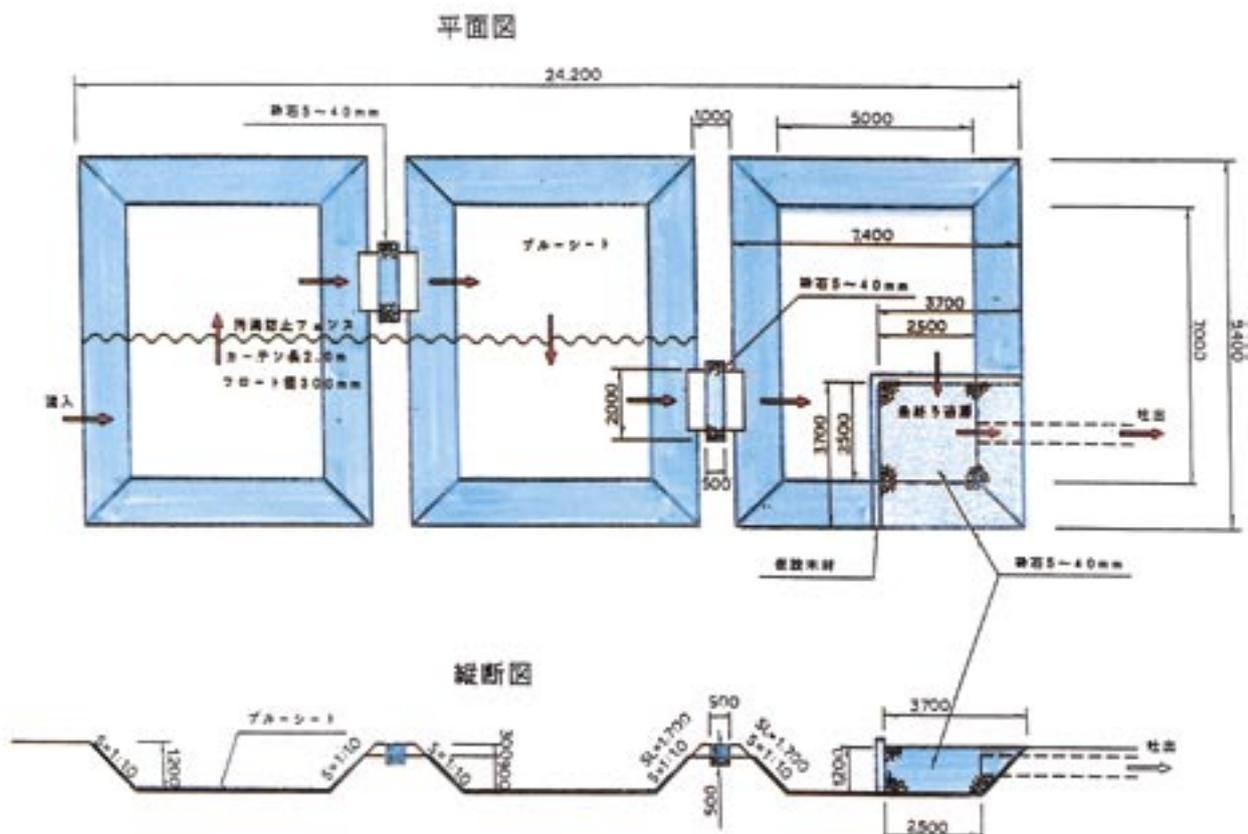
汚濁防止施設（沈砂池の平面図、縦断面図）
